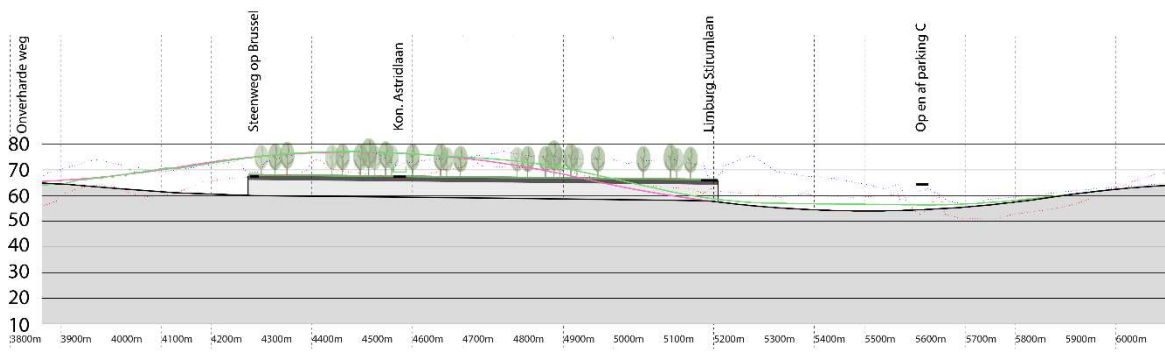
conceptsnede A alternatief light - onderzoeksvariant minimaal
